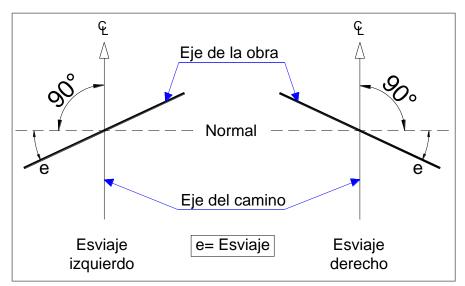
Eje de las alcantarillas, Ilustración, 2018
